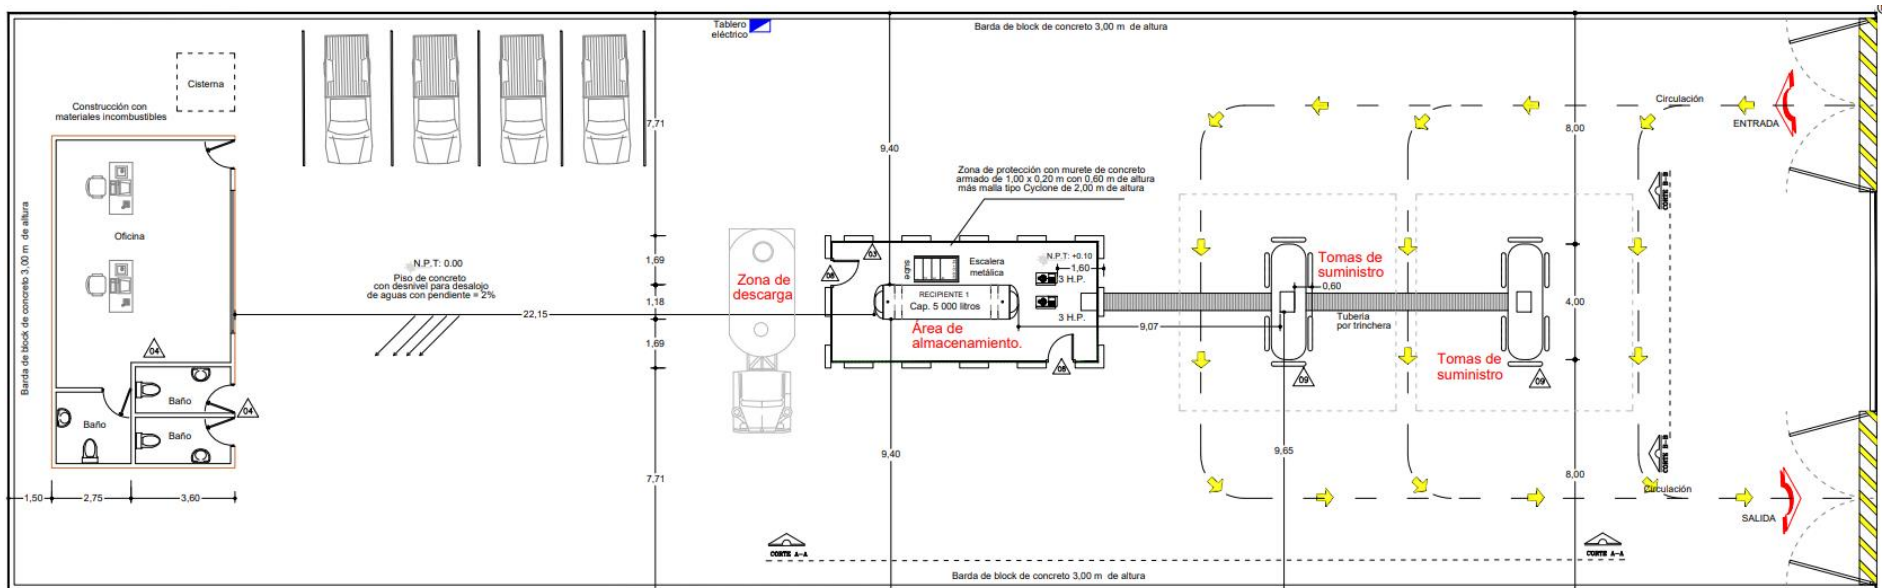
Plano de la planta general de la Estación de Gas L.P. para carburación
